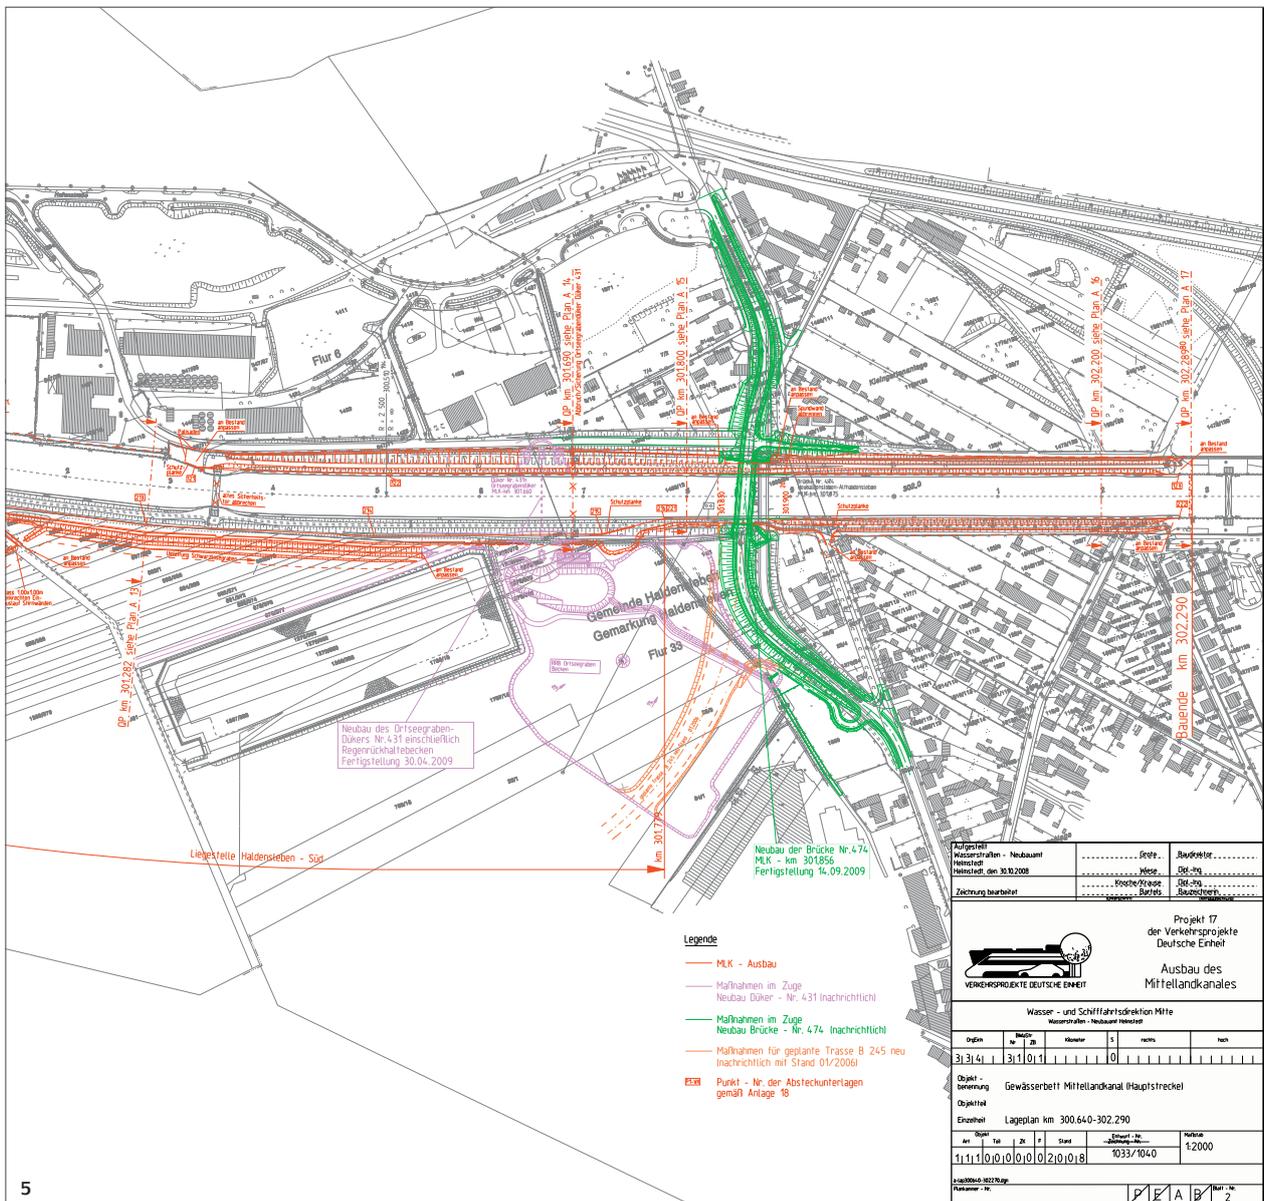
Ausbauplan Stadtstrecke Haldensleben, MLK-km 300,640 – 302,290
